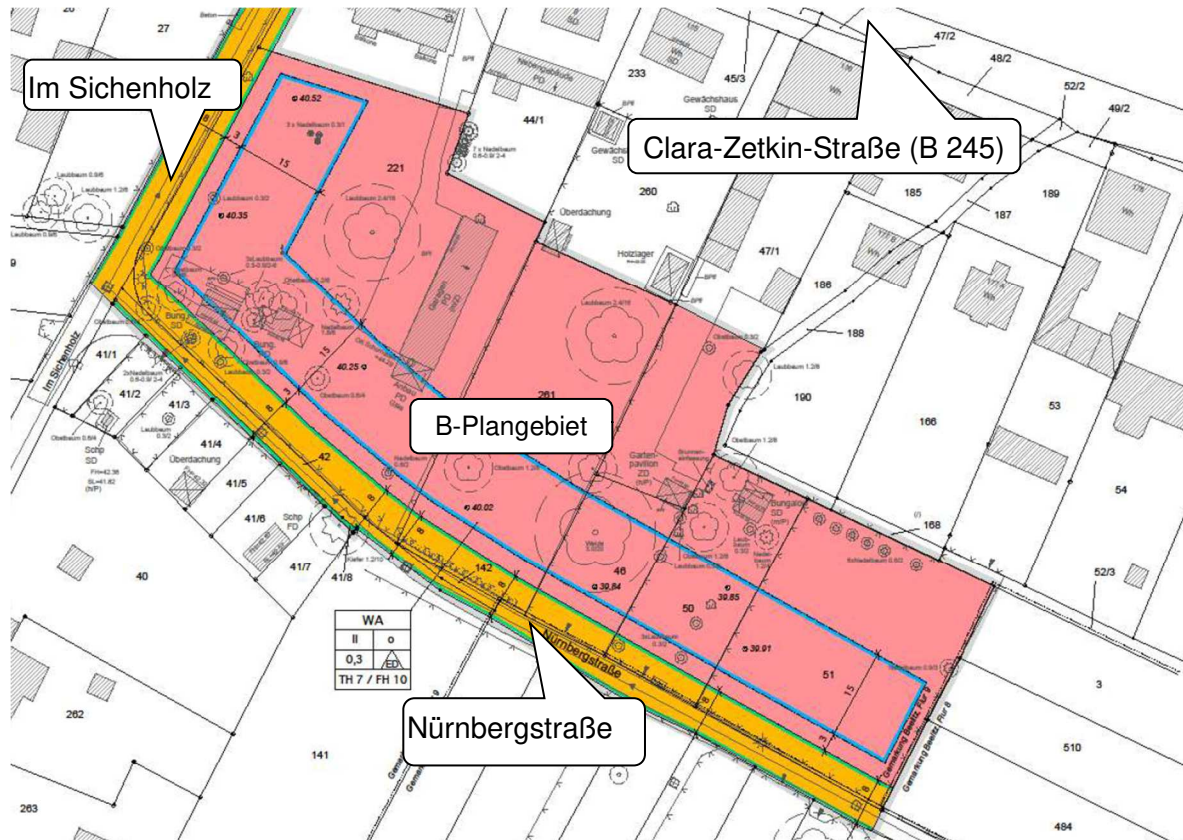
Bebauungsplangebiet „Nürnbergstraße – Im Sichenholz“ – Entwurf
